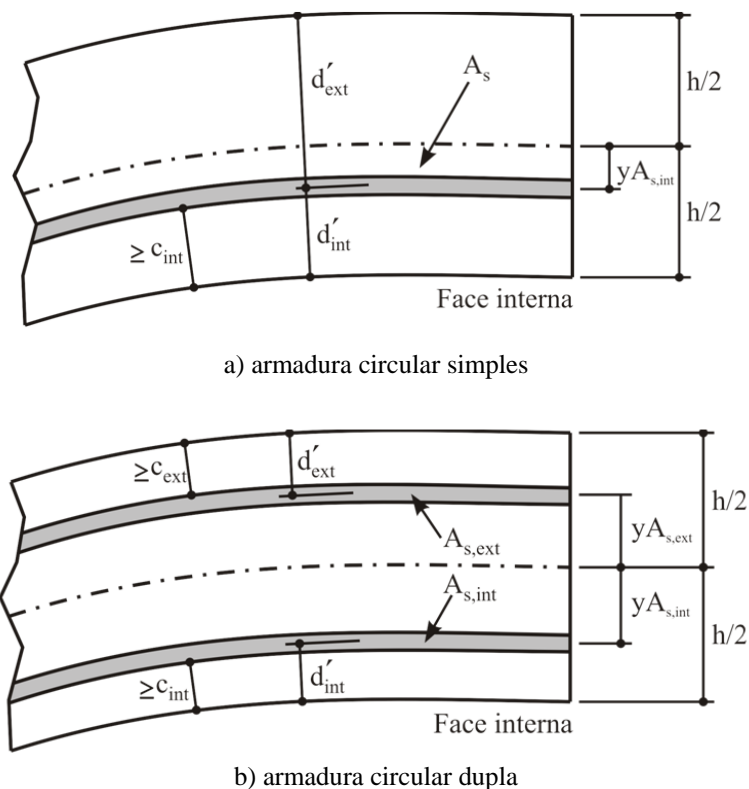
Posição da armadura na parede do tubo com arranjo de armadura circular.
